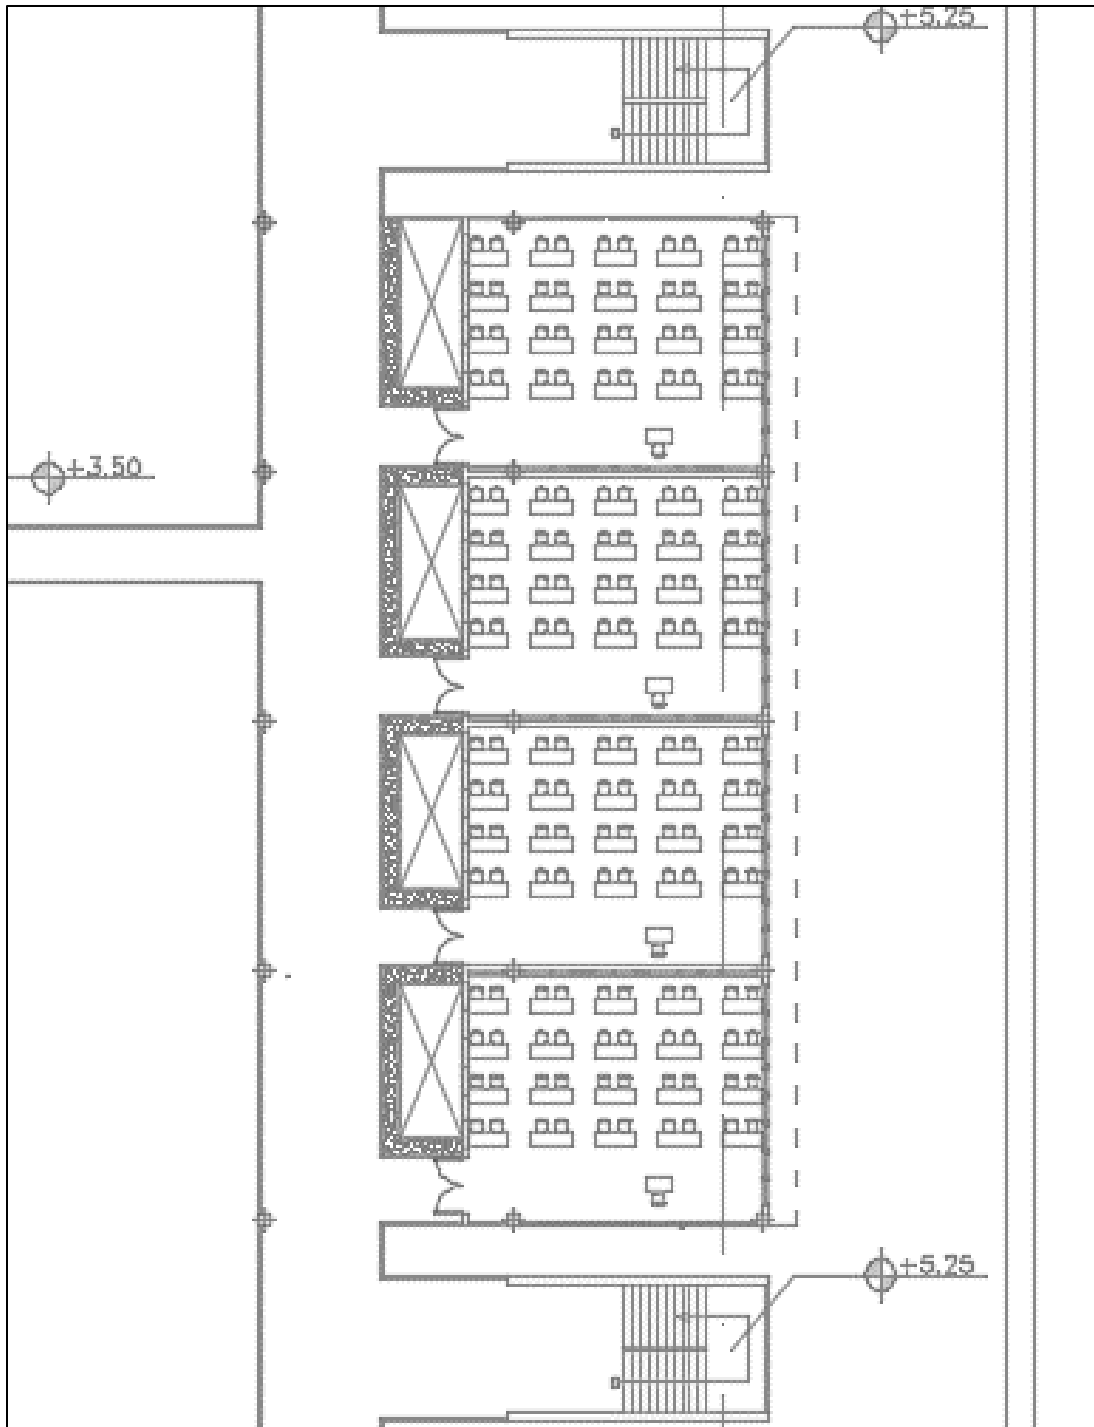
Planta Baja Módulo de Aulas II. Fuente: Propia autoría. (2018).
